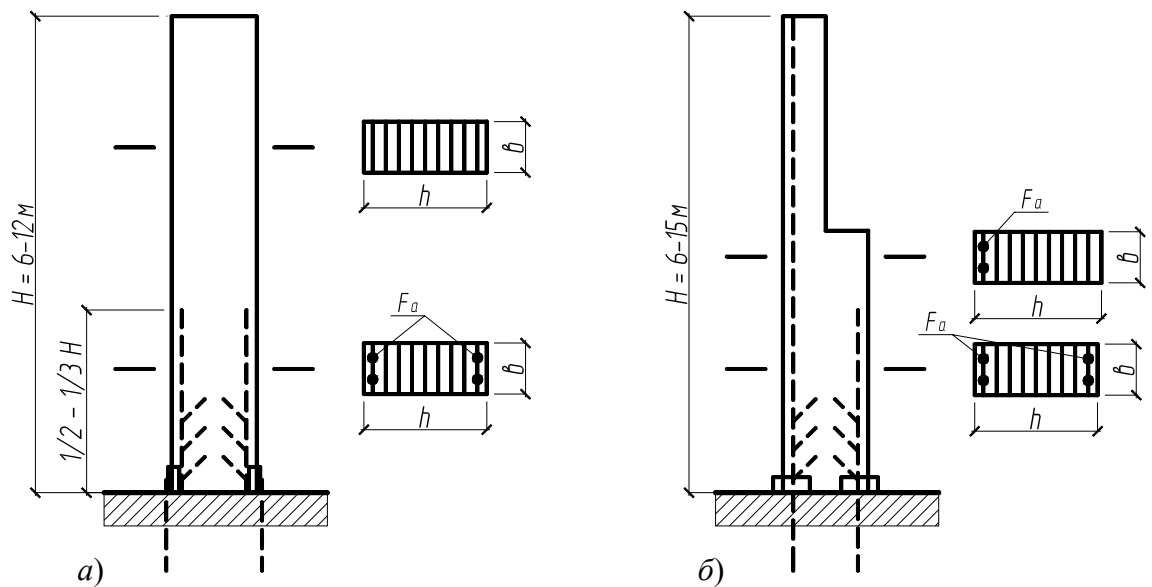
Клееные армированные колонны и стойки: а – постоянного сечения; б – ступенчатые
